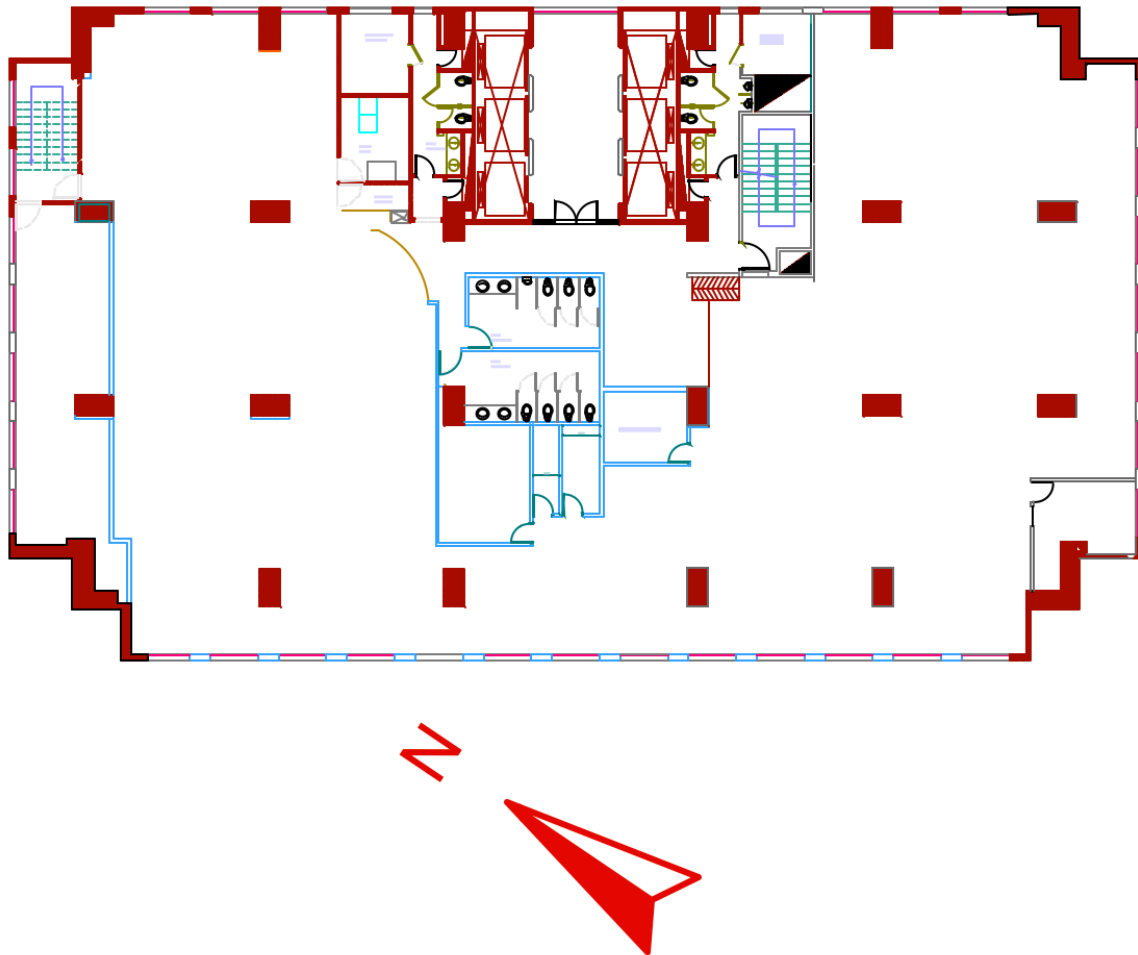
Planta Piso Tipo, Edificio Capital Tower
